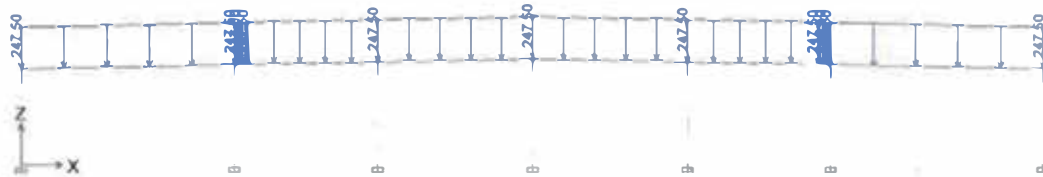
Aplicación de la Carga Muerta al Sistema Estructural.
